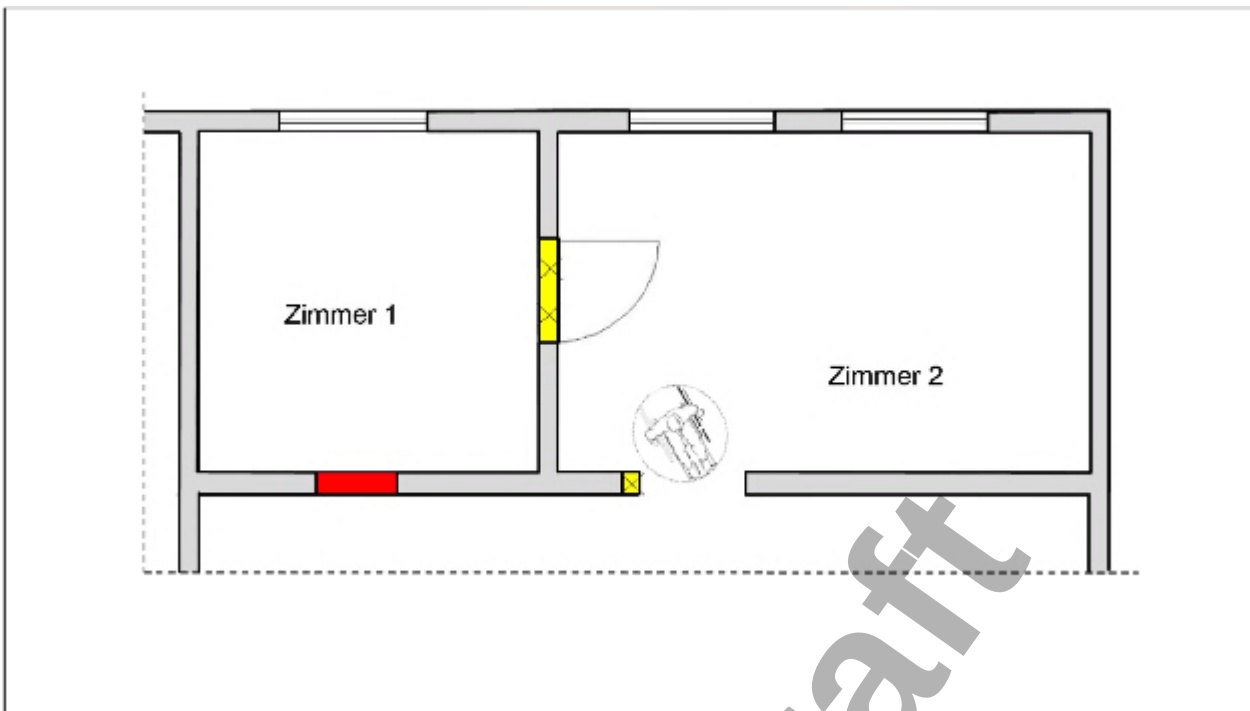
Bauen im Bestand – Nachträgliche Wandöffnungen
